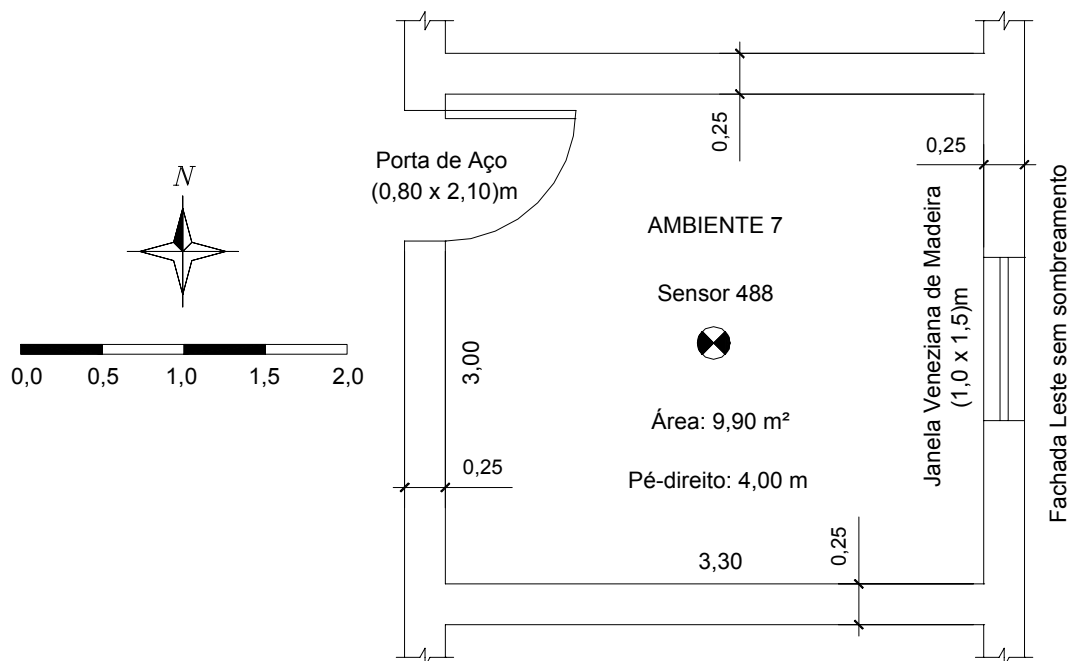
Planta baixa do ambiente monitorado - Edificação 7.
